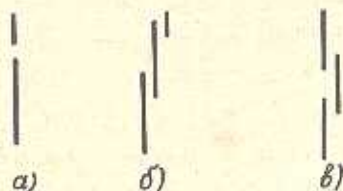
Соединение листов стенок вертикальных цилиндрических резервуаров
